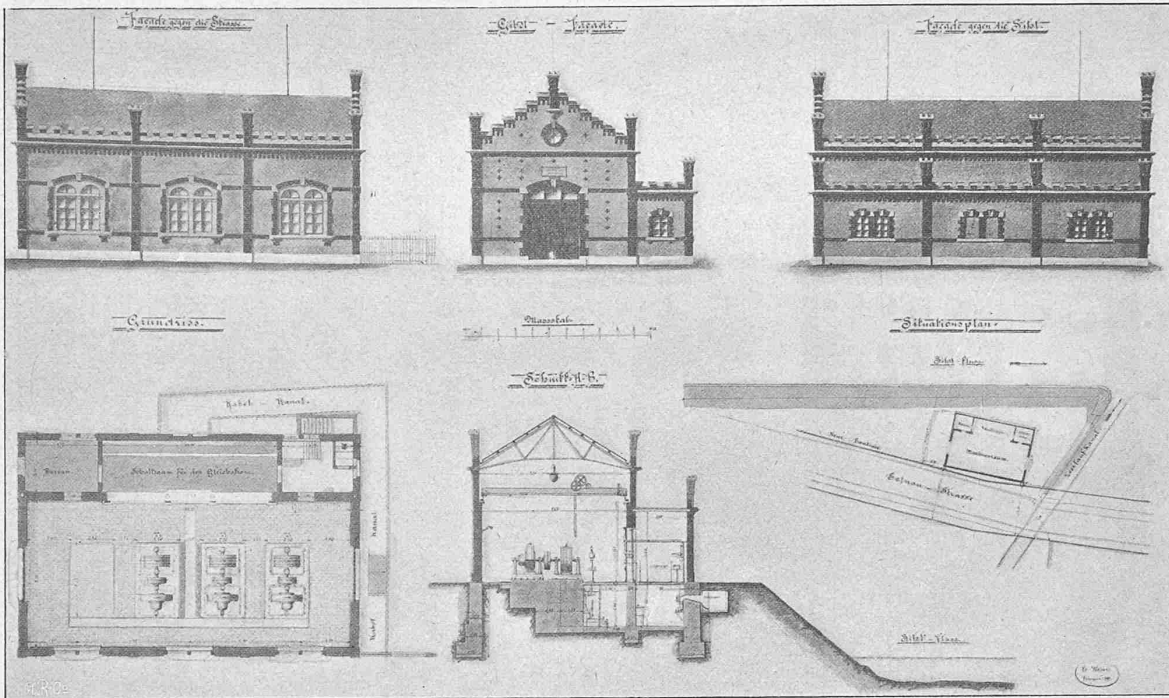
Umformerstation. — Lageplan, Grundriss, Fassaden und Querschnitt 1:400.
